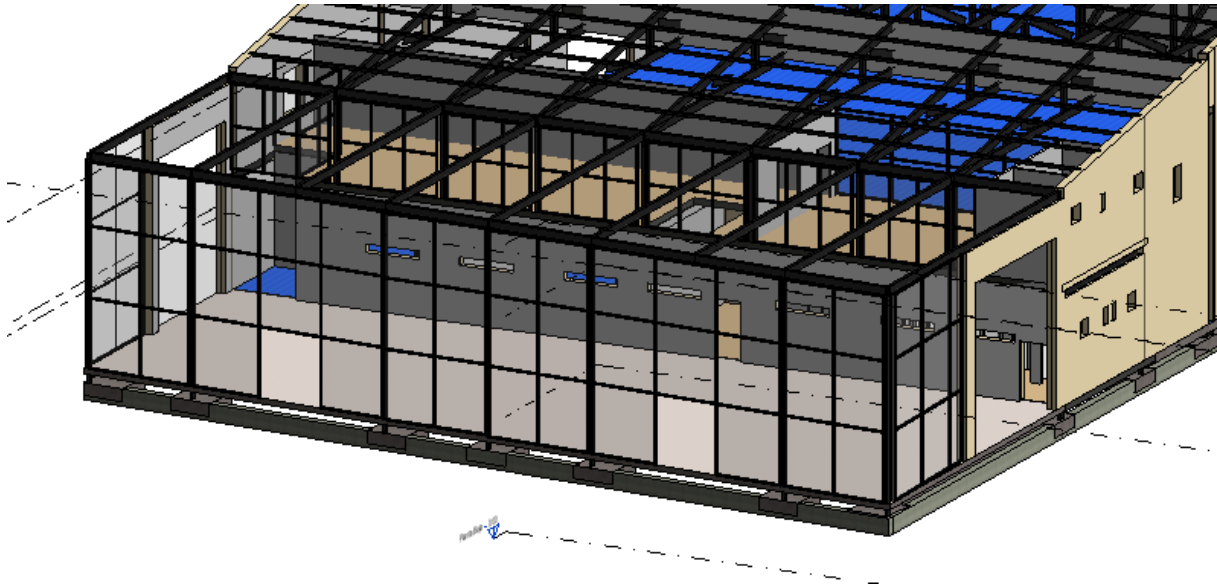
Cristalerías en la exposición de vehículos y en la primera planta
